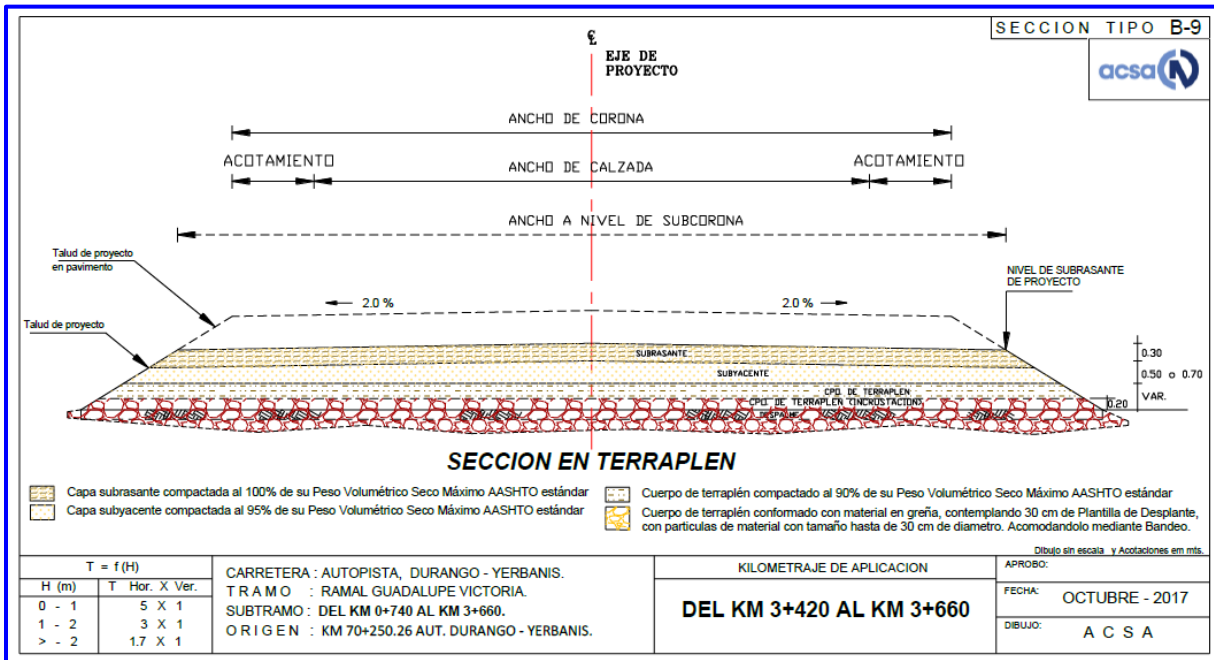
SECCIÓN ESTRUCTURAL TIPO (EN TERRAPLÉN)
